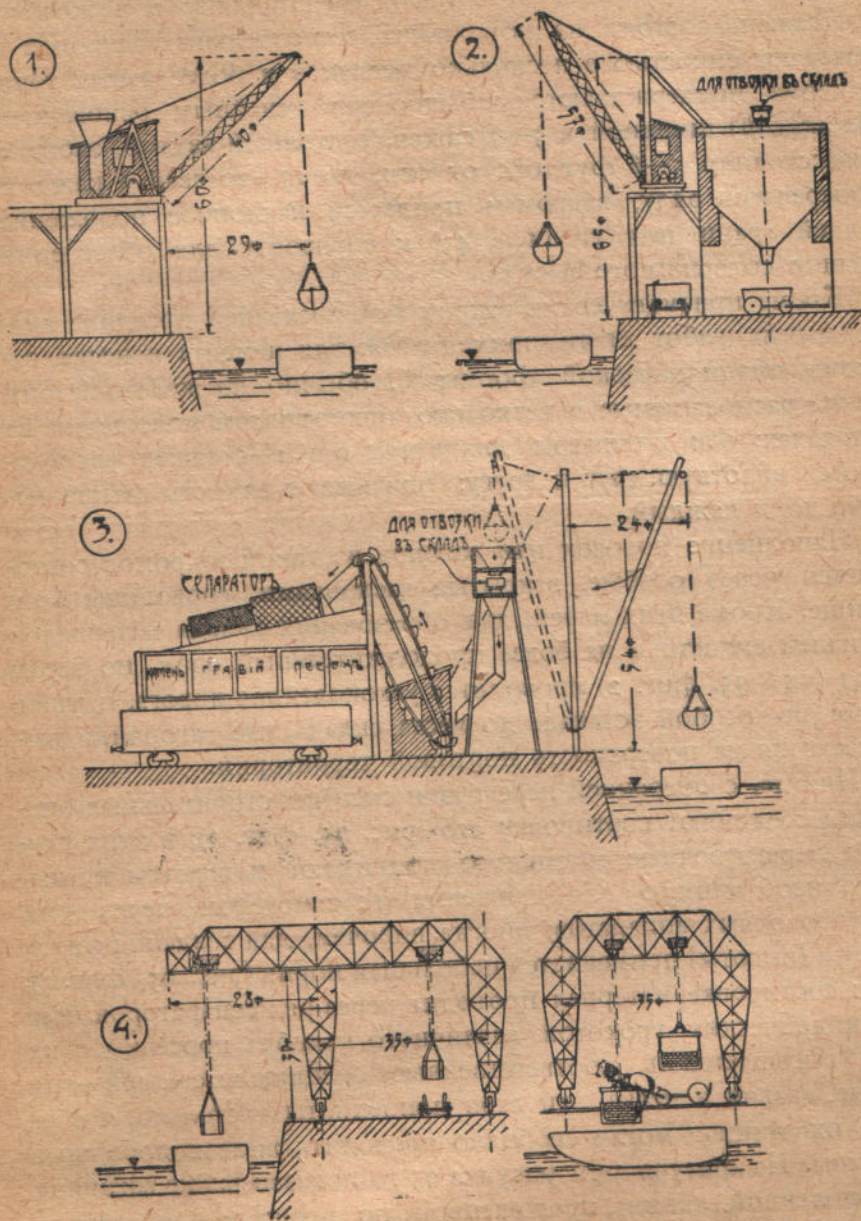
Схемы некоторых механических устройств для перегрузки строительных материалов.
